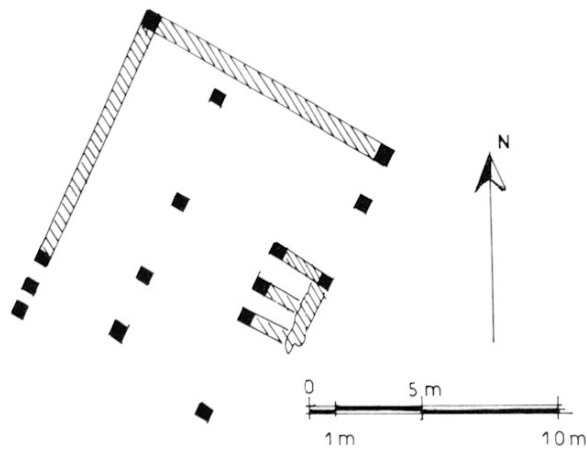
Djemaa Mellah : croquis des ruines (en hachures, murs de blocage à mortier de chaux).
